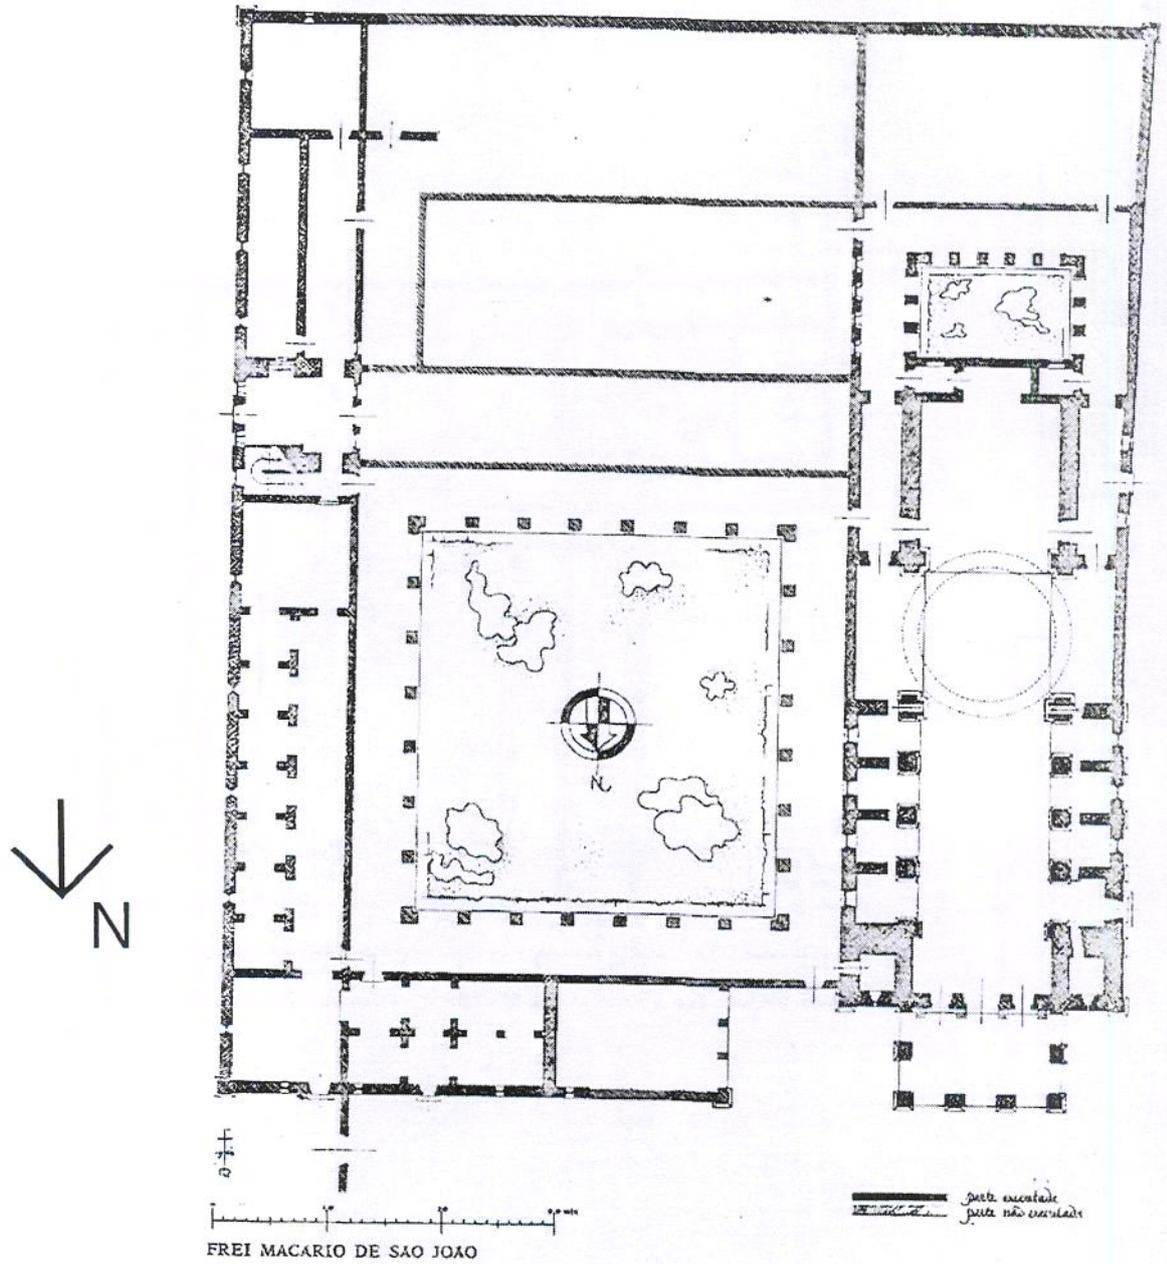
Mosteiro de São Bento de Salvador - Planta do pavimento térreo.
